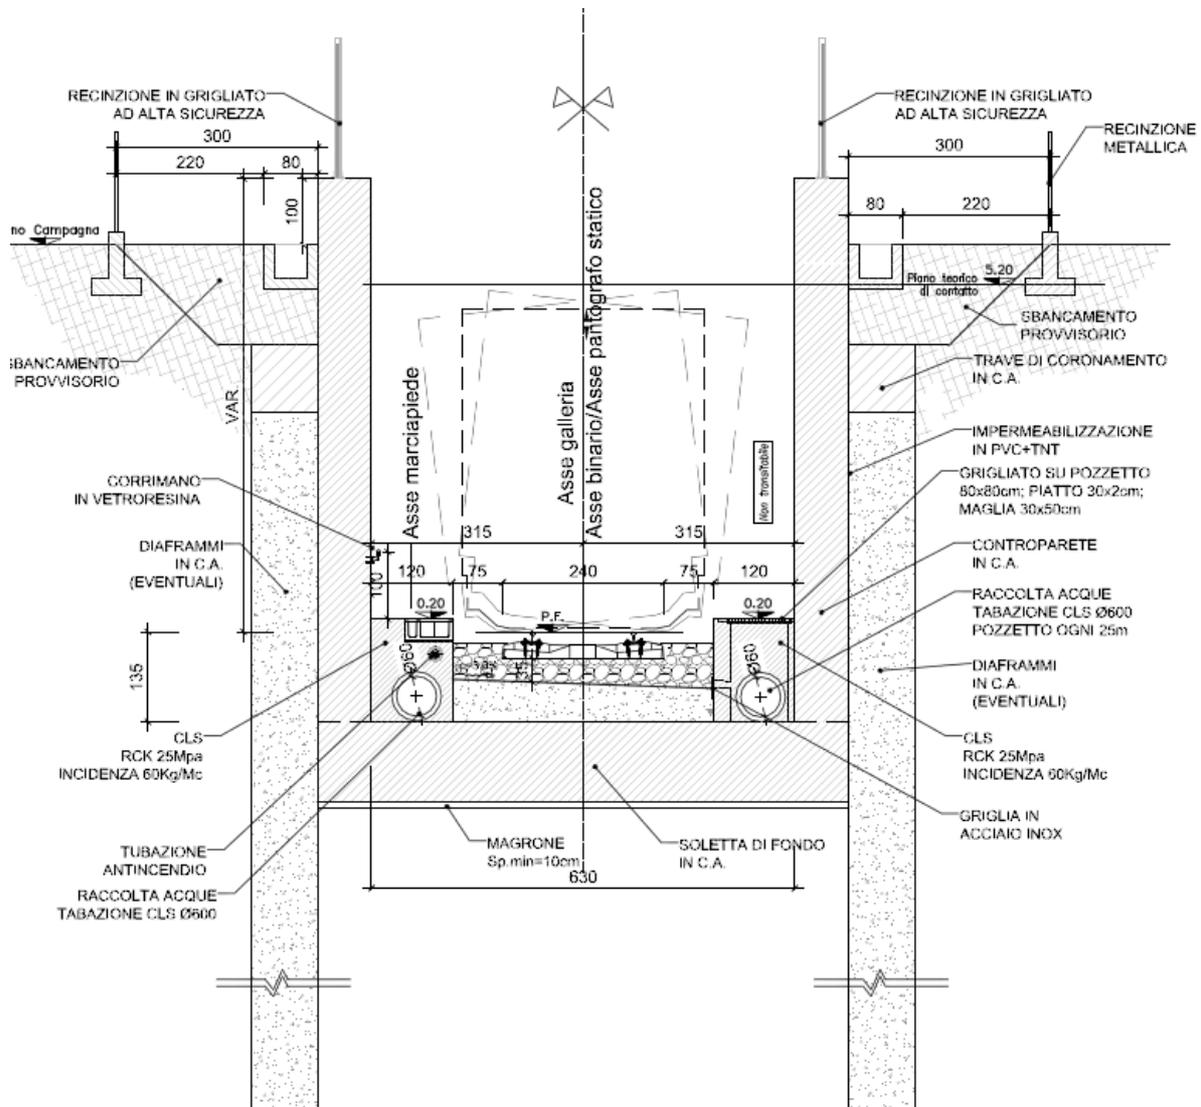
Sezione tipo Trincea monobinaria tra diaframmi
